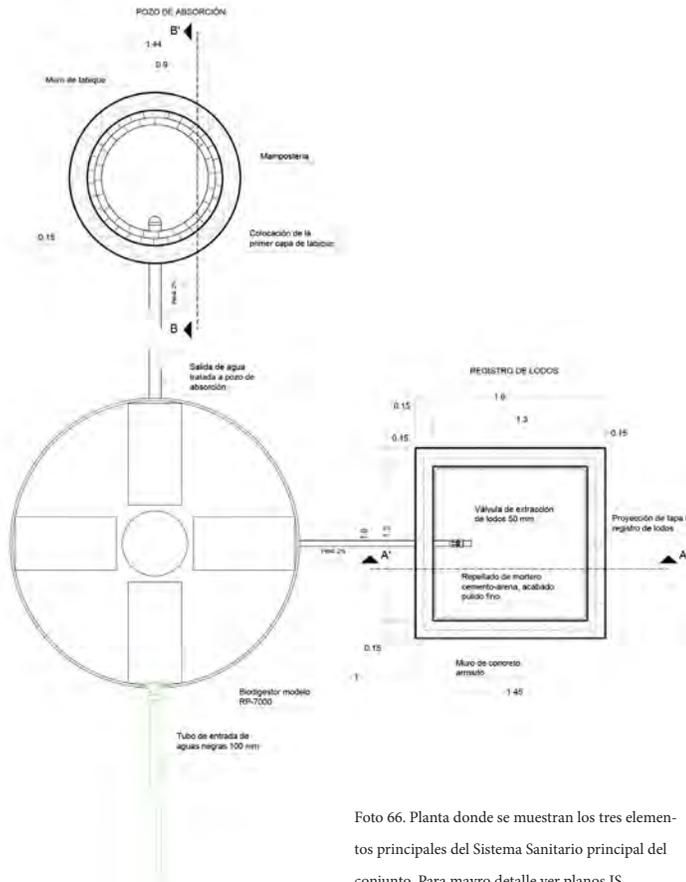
Planta donde se muestran los tres elementos principales del Sistema Sanitario principal del conjunto. Para mayor detalle ver planos IS.
